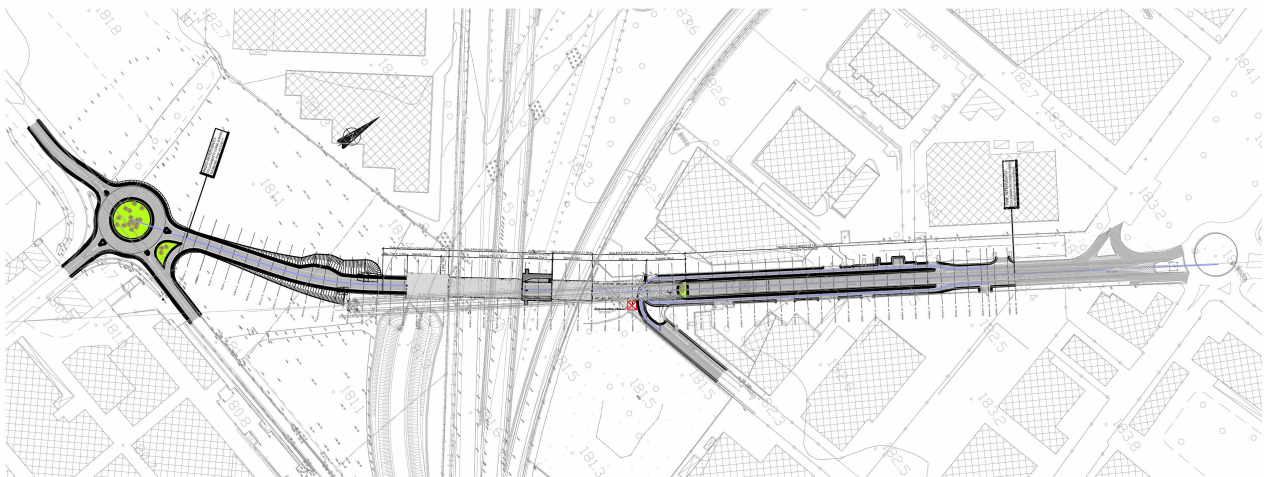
Planimetria di progetto Galleria artificiale S.P.n.101
